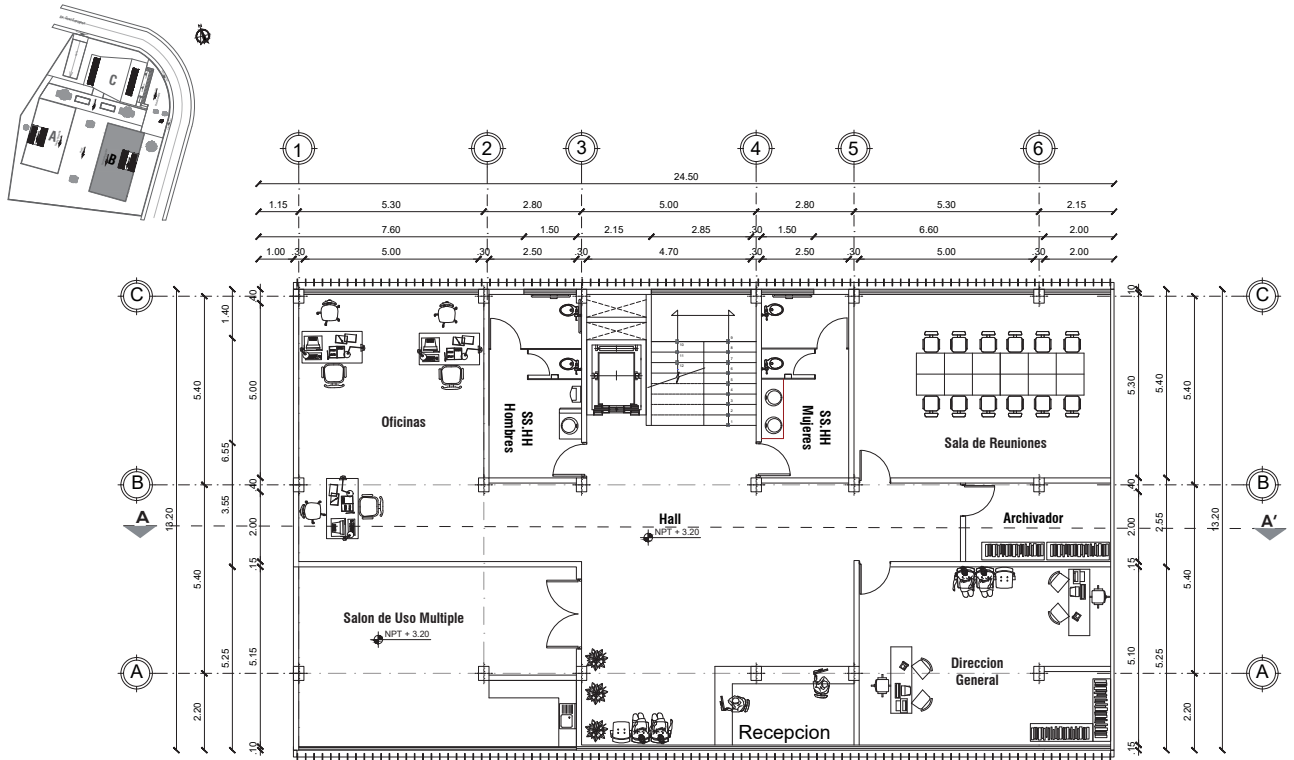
Planta Arquitectonica de Administracion Primer Nivel
